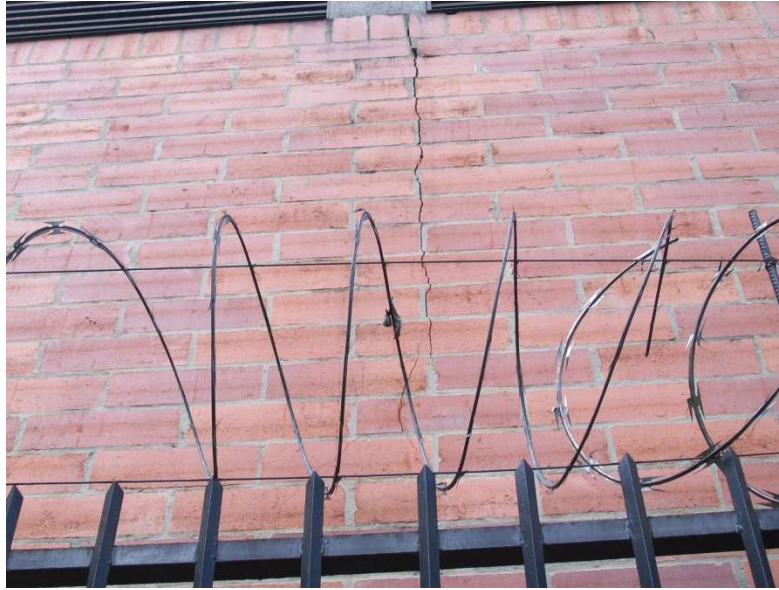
Fisura vertical sobre fachada (archivo parque industrial)
